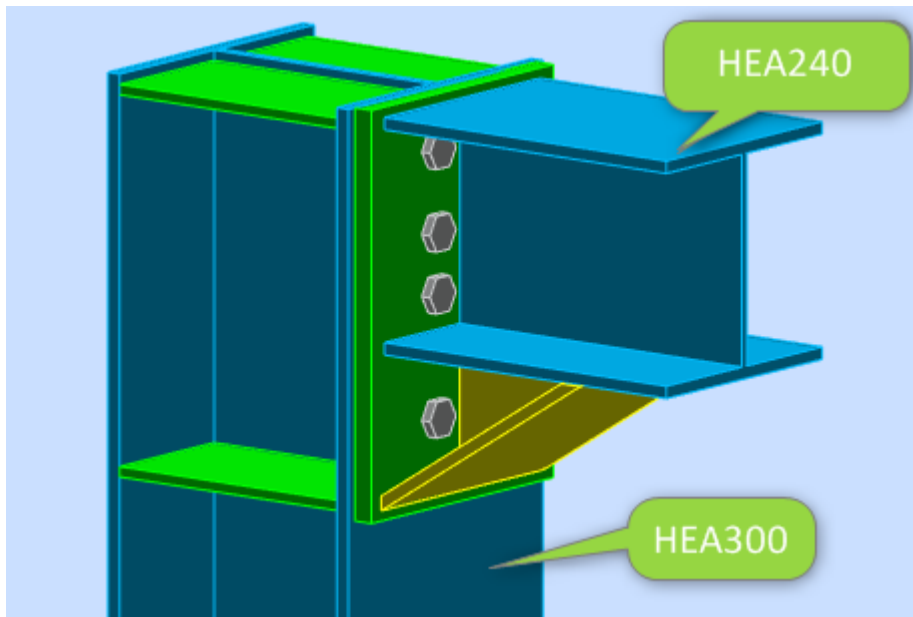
Assemblage poutre principale- poteau (HEA240-HEA300).
